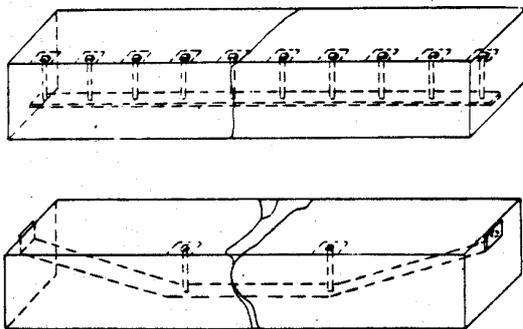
Vigas de ensaio de Hyatt com indicação das armaduras e das trincas.
